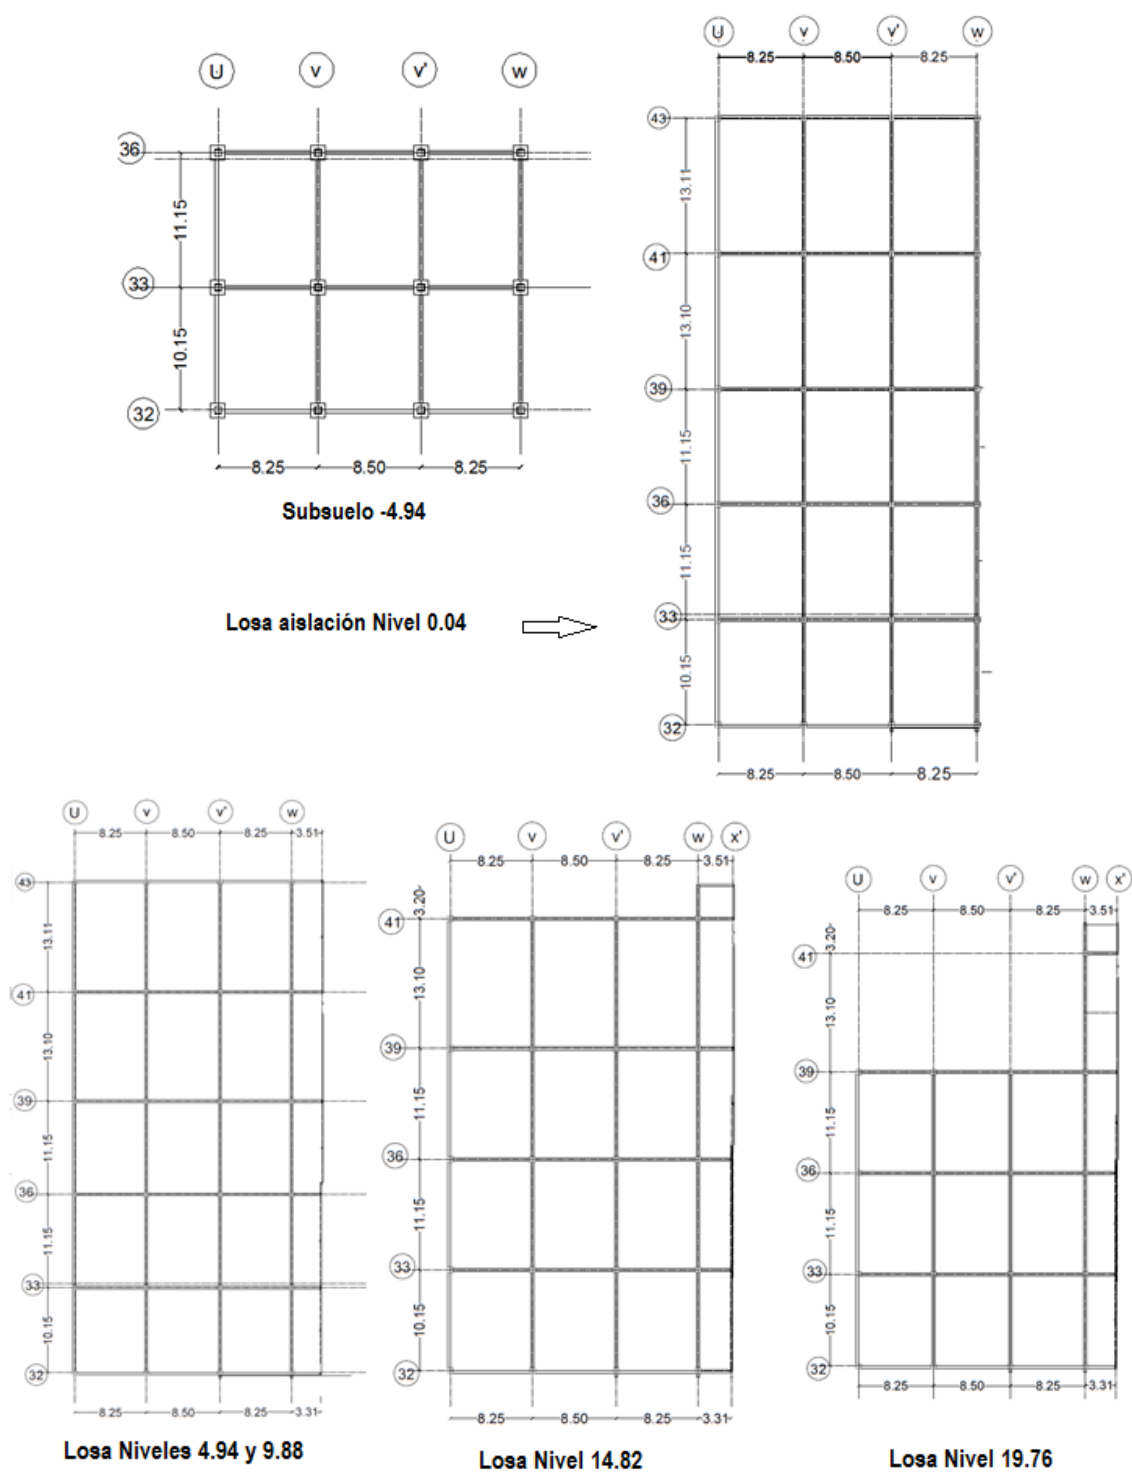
Plantas del Bloque Estructural 67 de la UFA-ESPE.
